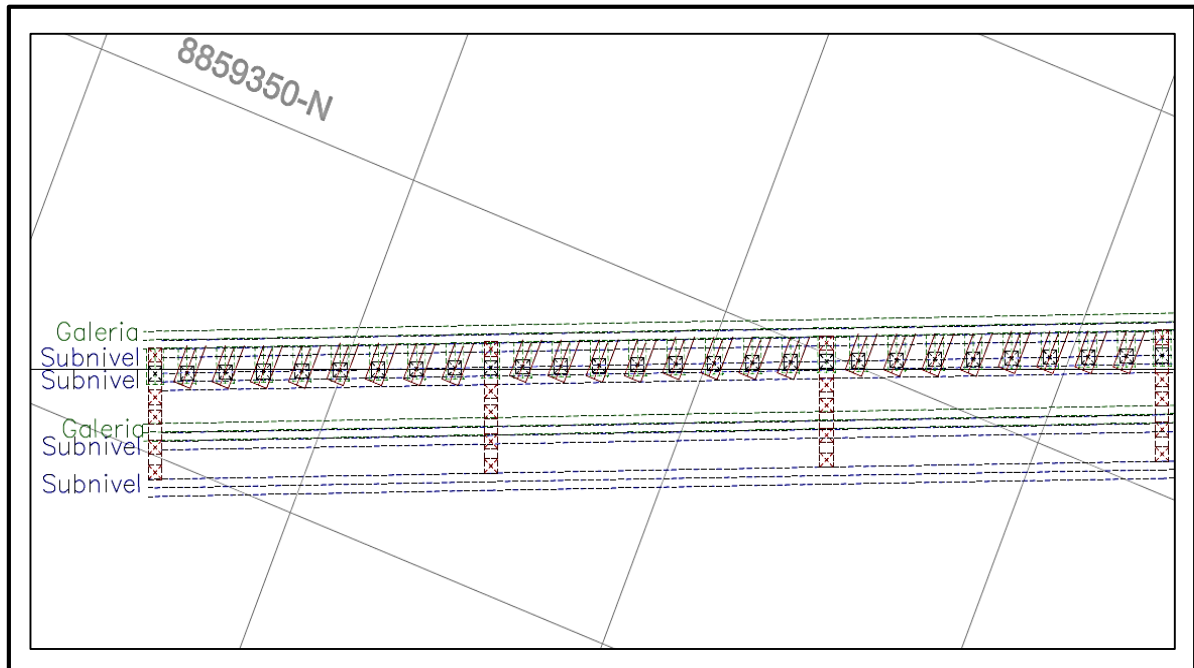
Vista en Planta del Método Shrinkage Dinámico.
